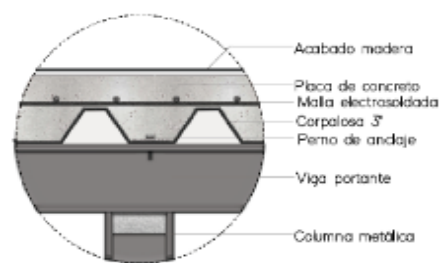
Corte fachada vista desde zonas de exposición. Elaboración propia.
